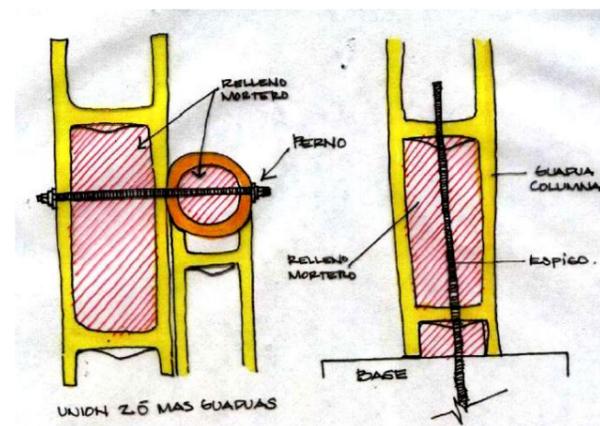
Esquema del sistema estructural de caña guadúa con los elementos de hormigón armado y acero (pernos). (Arq. Jorge Morán, 2007)
